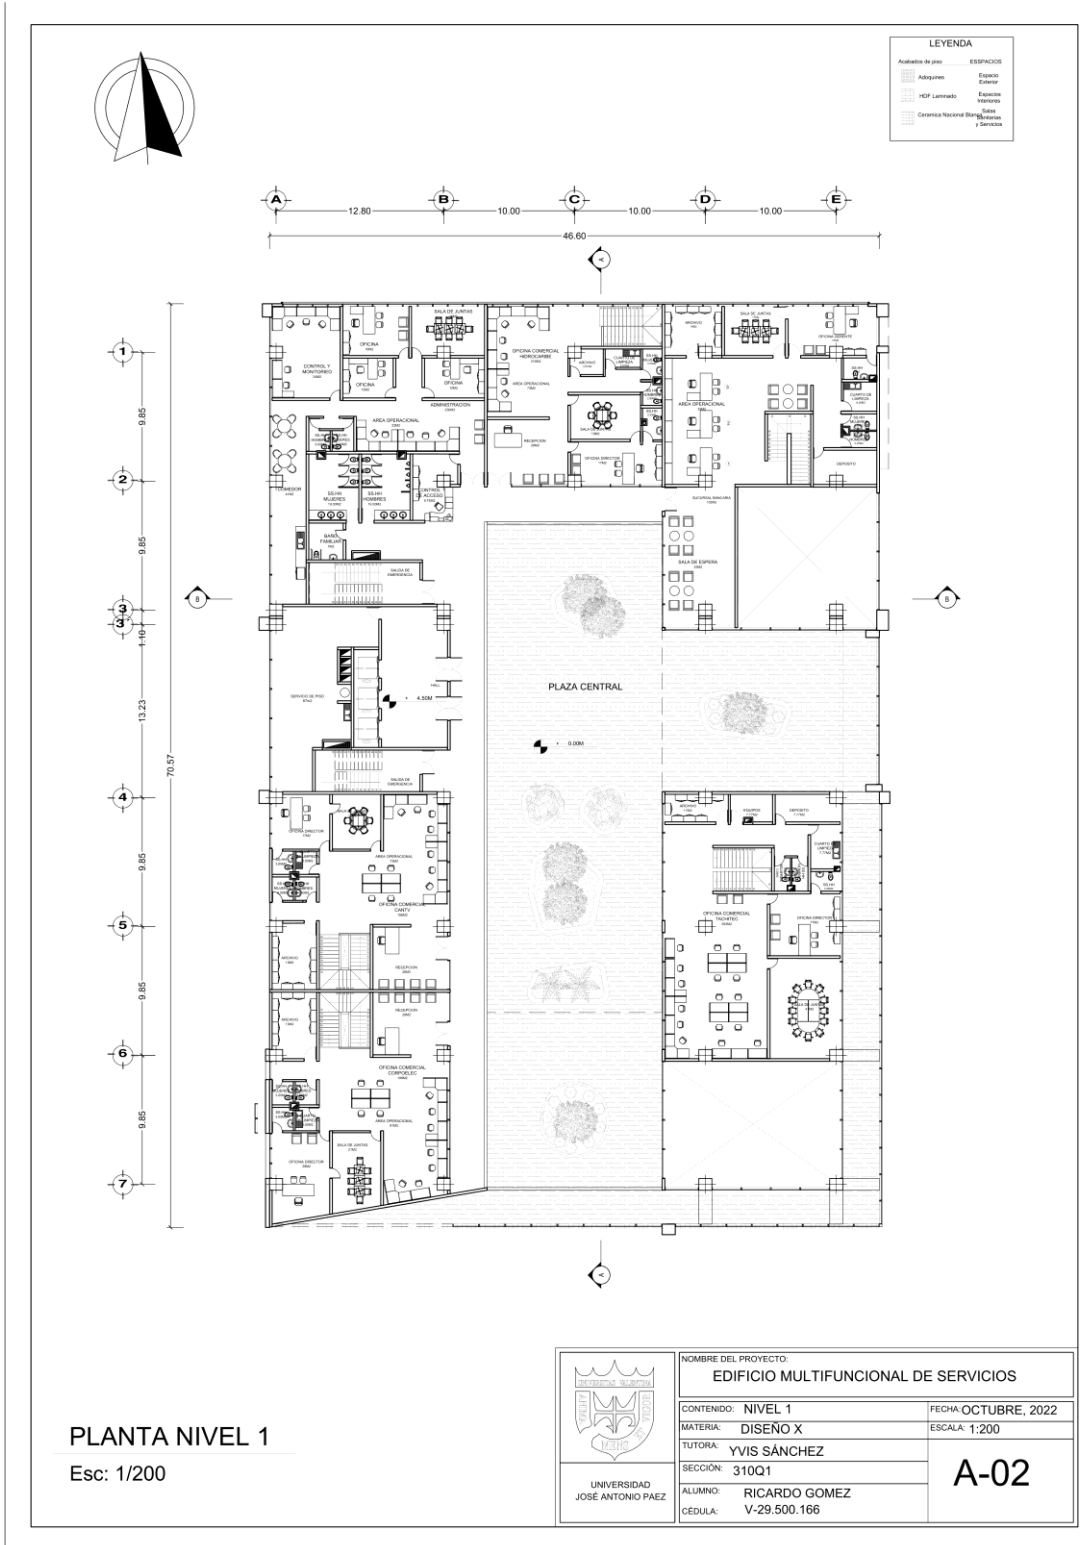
Planta nivel 1. Fuente: El Autor (2022).
